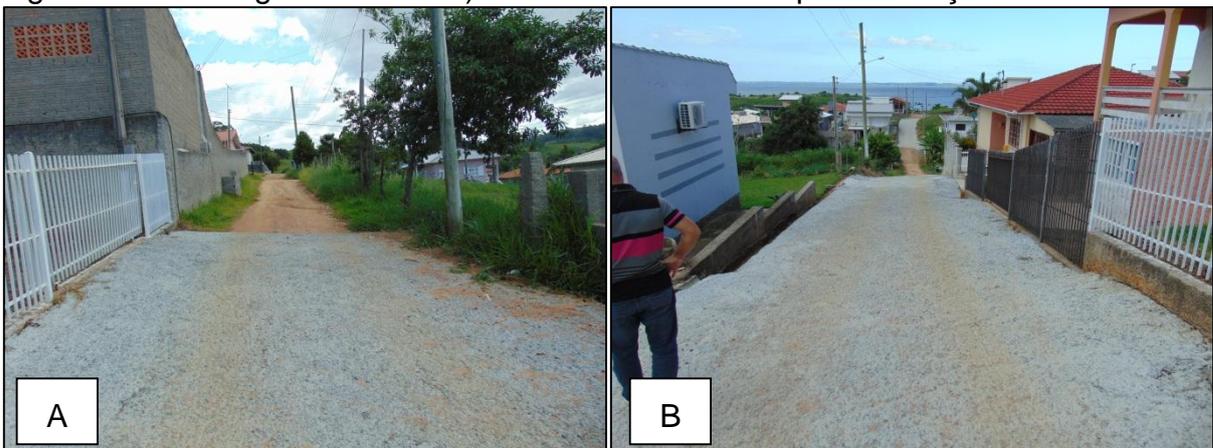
A) Visão geral da rua. B) Material utilizado na pavimentação.
